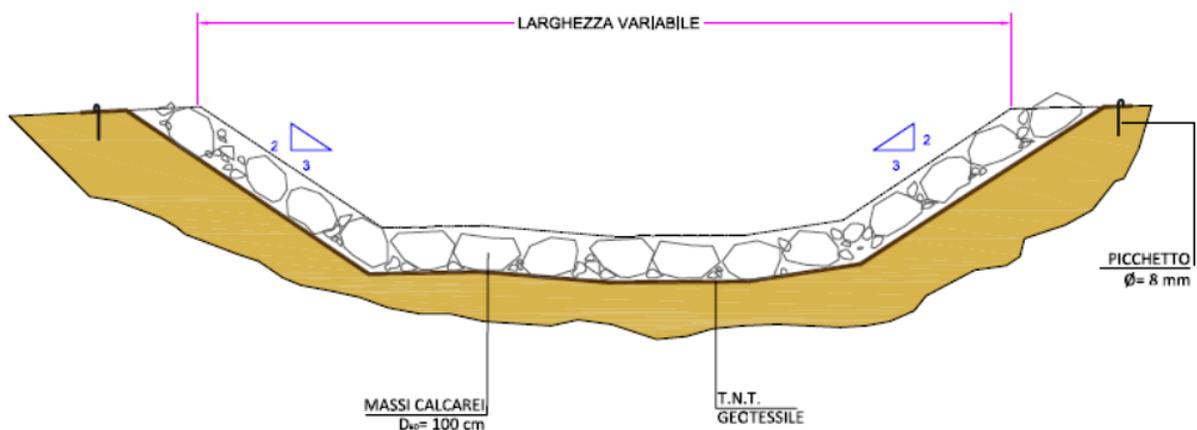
Sistemazione a scogliera nei tratti di fiume interessati dalla rimozione del guado
